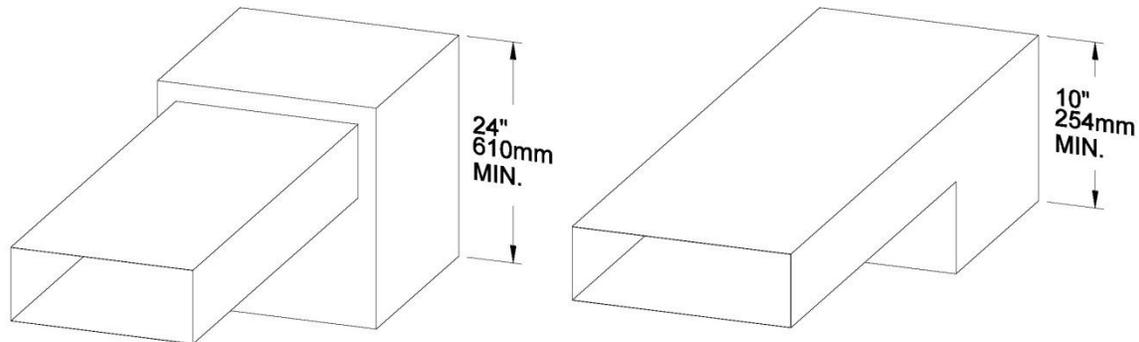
c - Hauteur minimale du plenum d'air chaud.
